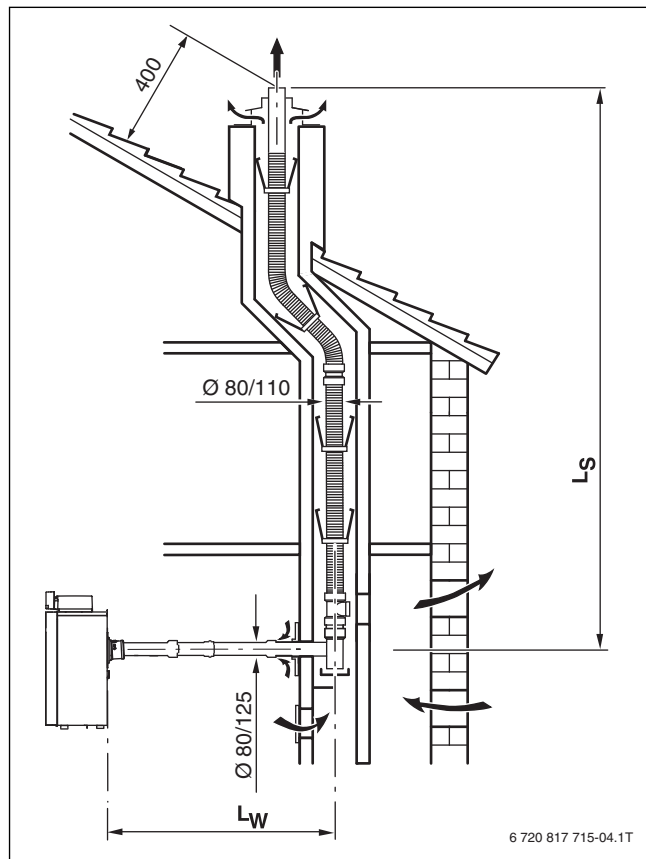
Conducción por tubo individual en la chimenea, (B<sub>33</sub>, flexible)
